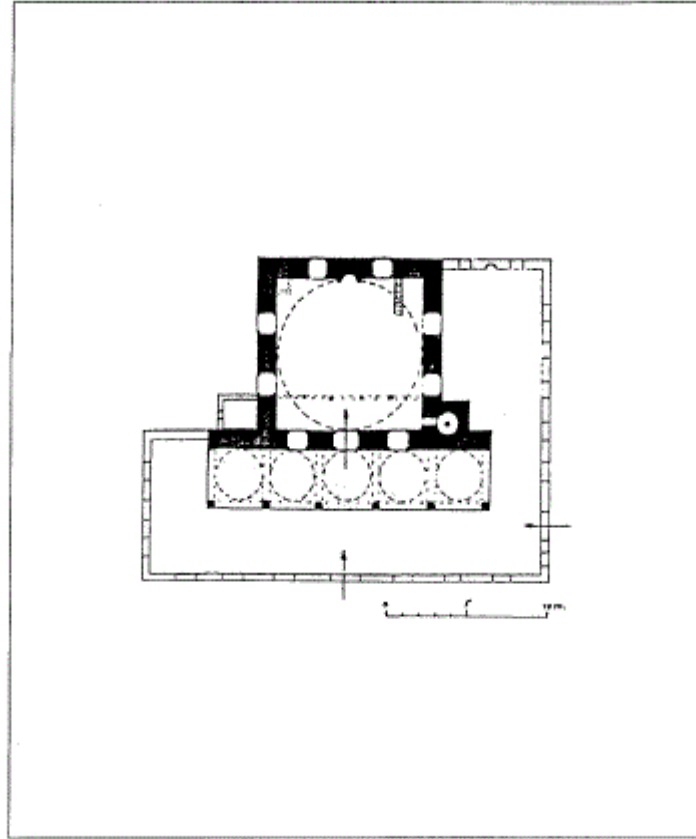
مسقط أفقي لمسجد حمزة بك في سالونيك (سلاطيك) (عن : كيل) .
